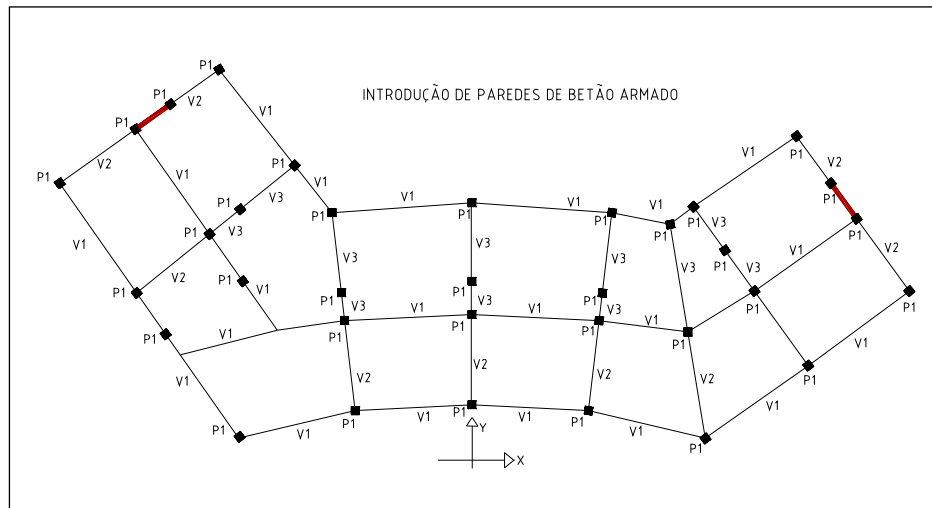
Planta estrutural do edifício reforçado com introdução de paredes de betão.
